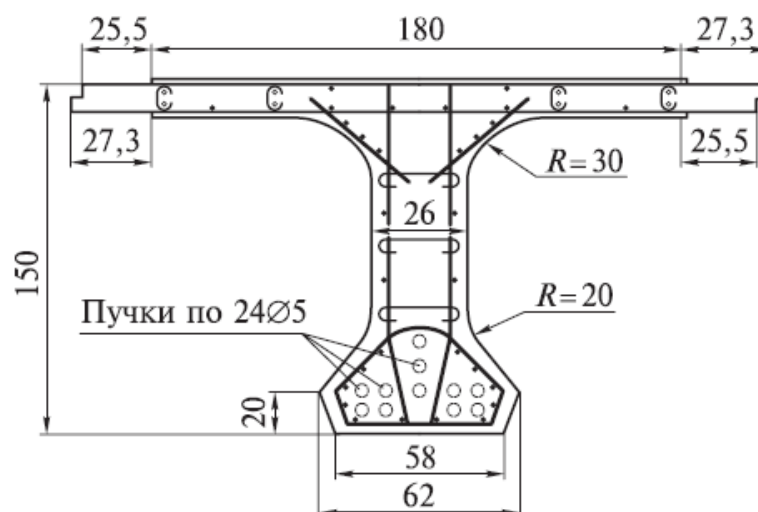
Поперечное сечение ребристых балок в пролете и на опоре и их армирование ненапрягаемой и напрягаемой арматурой
